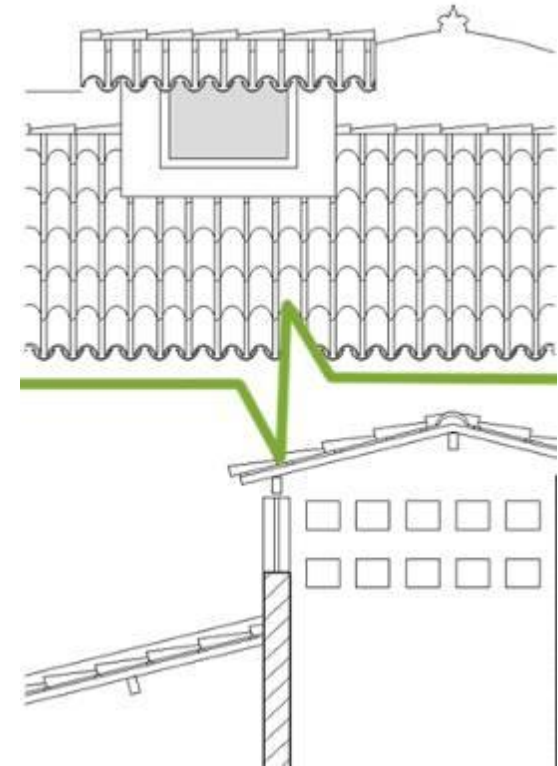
HCPA-37. Desenho esquemático, telha de ventilação.
